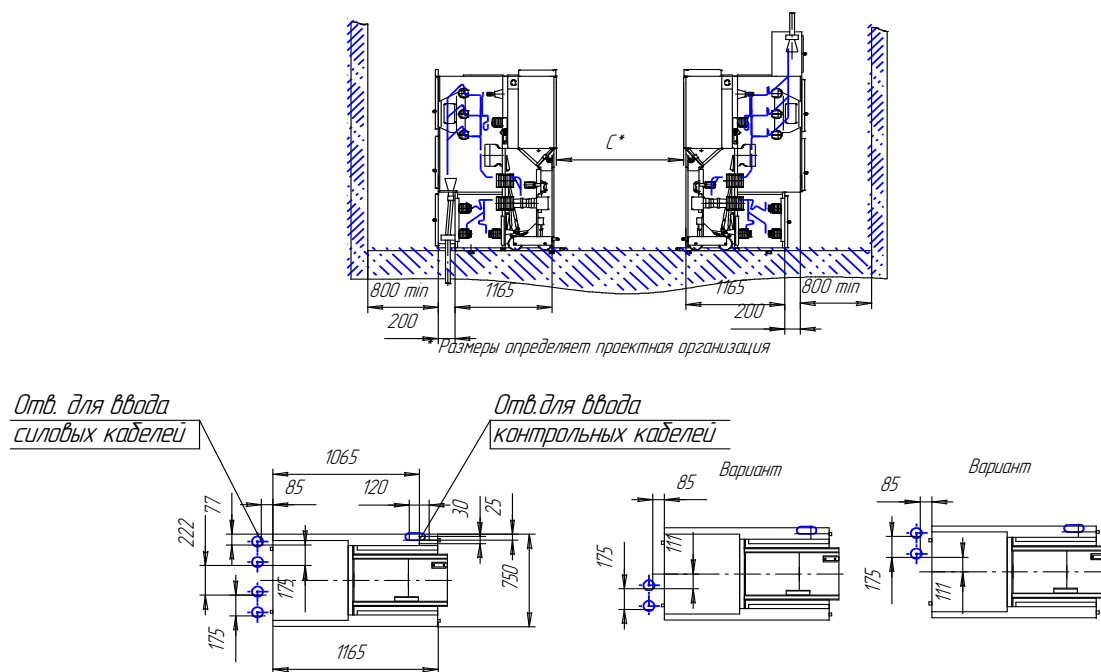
Установка шкафов с кабельным вводом снизу внутри и с кабельным вводом сверху на фундамент
